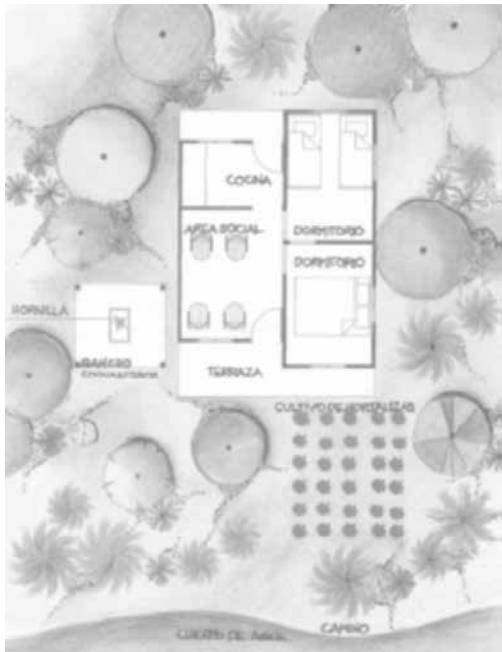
Esquema en planta de la vivienda mínima inestable intermedia
